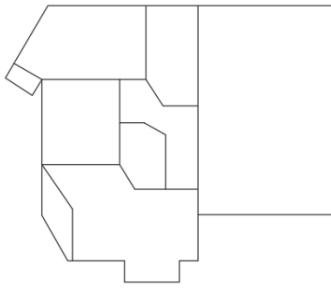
Planta do modelo 04-1961/80-1"
